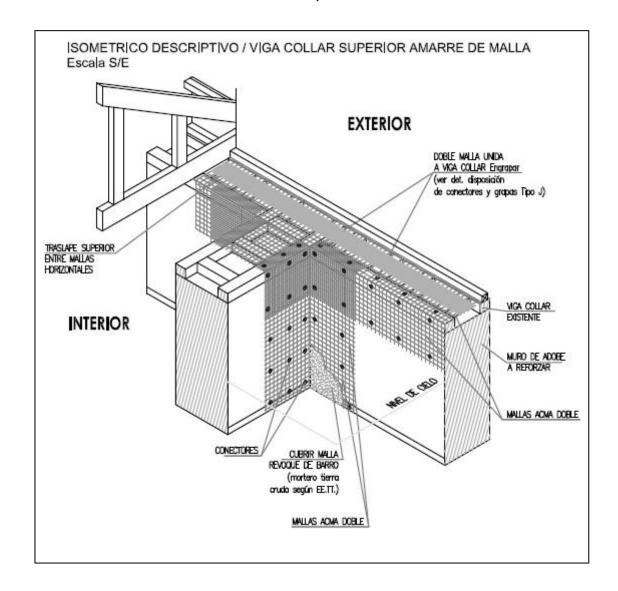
Proceso de reparación de vivienda adobe Peralillo. Fuente: Proyecto reconstrucción Zócalo arquitectura
